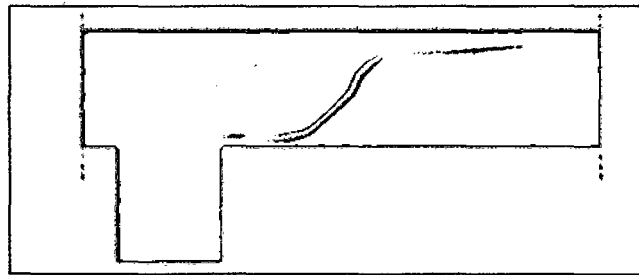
7. Fisuración por fallo de anclaje. Fuente: (Stuardo P., 2008)
